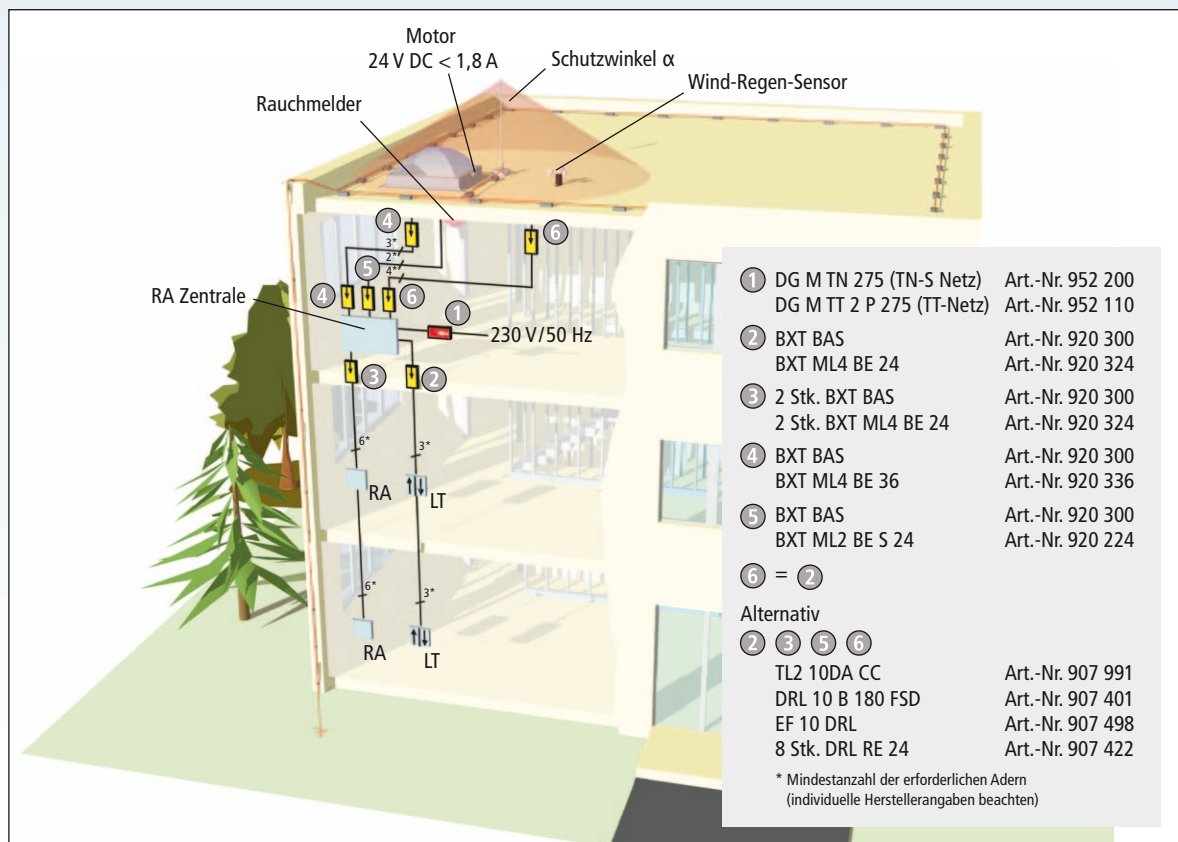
Lichtkuppel im Schutzraum einer Fangstange auf einem nichtmetallenem Dach einer baulichen Anlage mit Äußerem Blitzschutz
